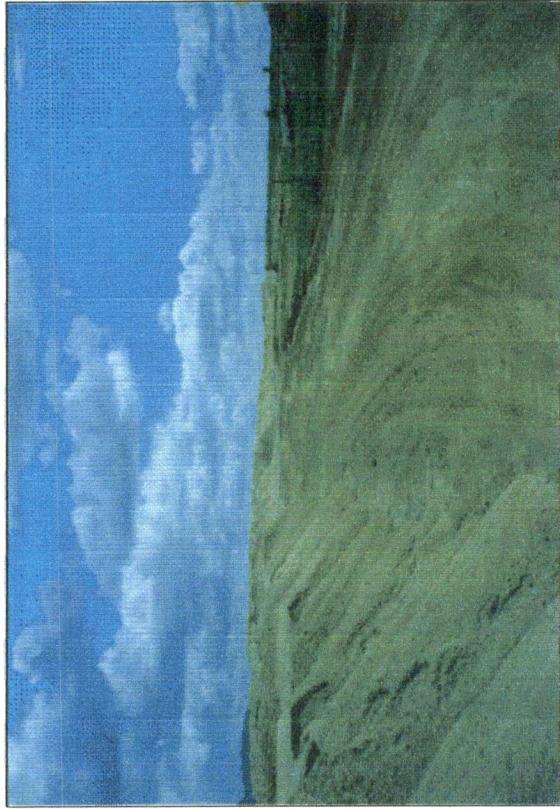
Colocação de areia grossa para dreno horizontal.
